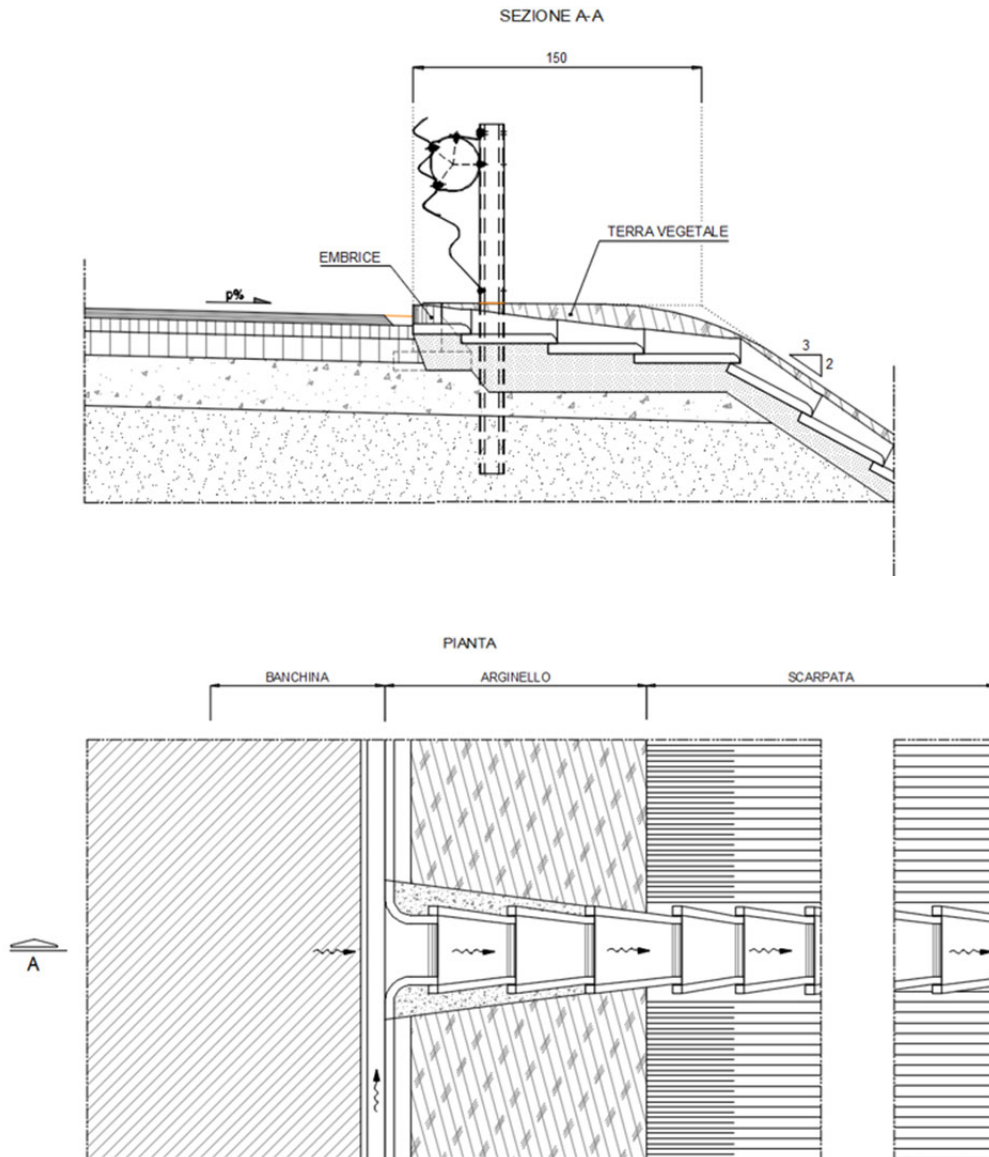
Raccolta delle acque di piattaforma da sezione in rilevato
